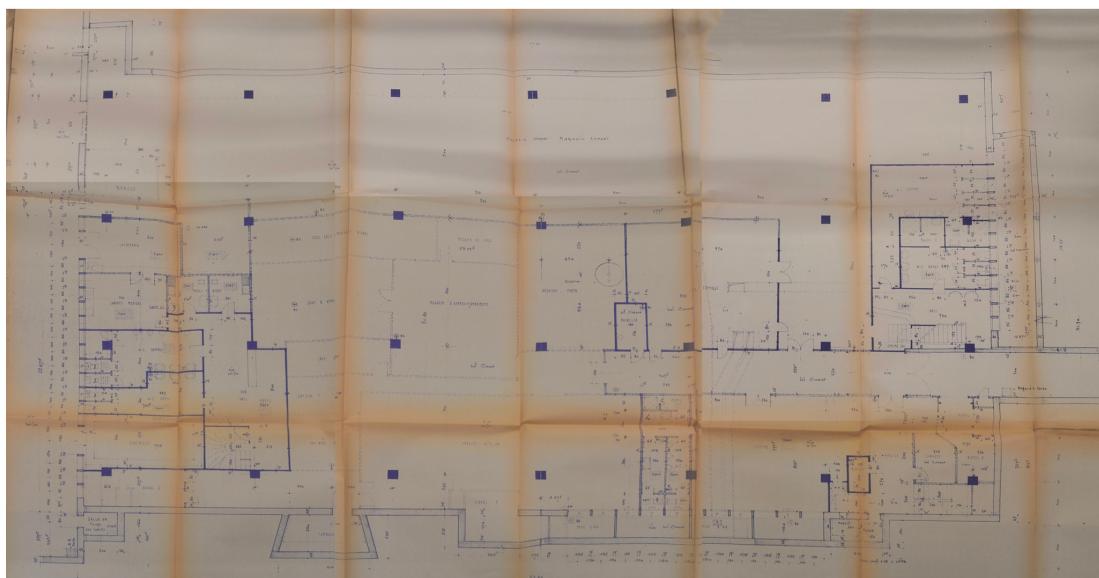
Solution présentée par Air France, aérogare de Toulouse-Blagnac, plan du rez-de-chaussée, 1967
